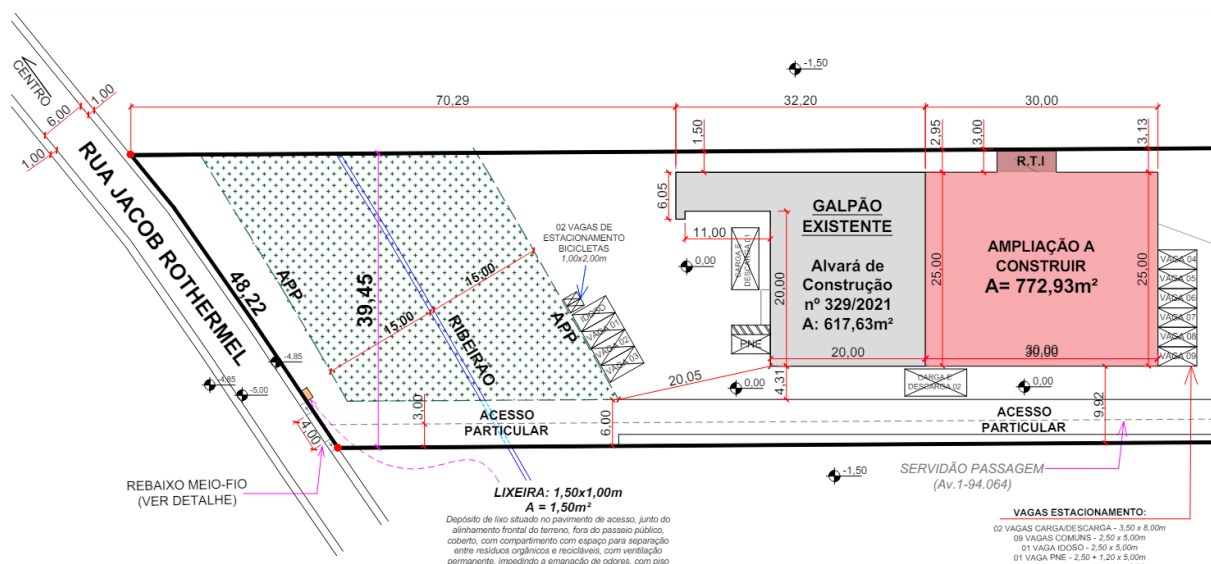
Planta de locação do empreendimento com layout das vagas de estacionamento.
